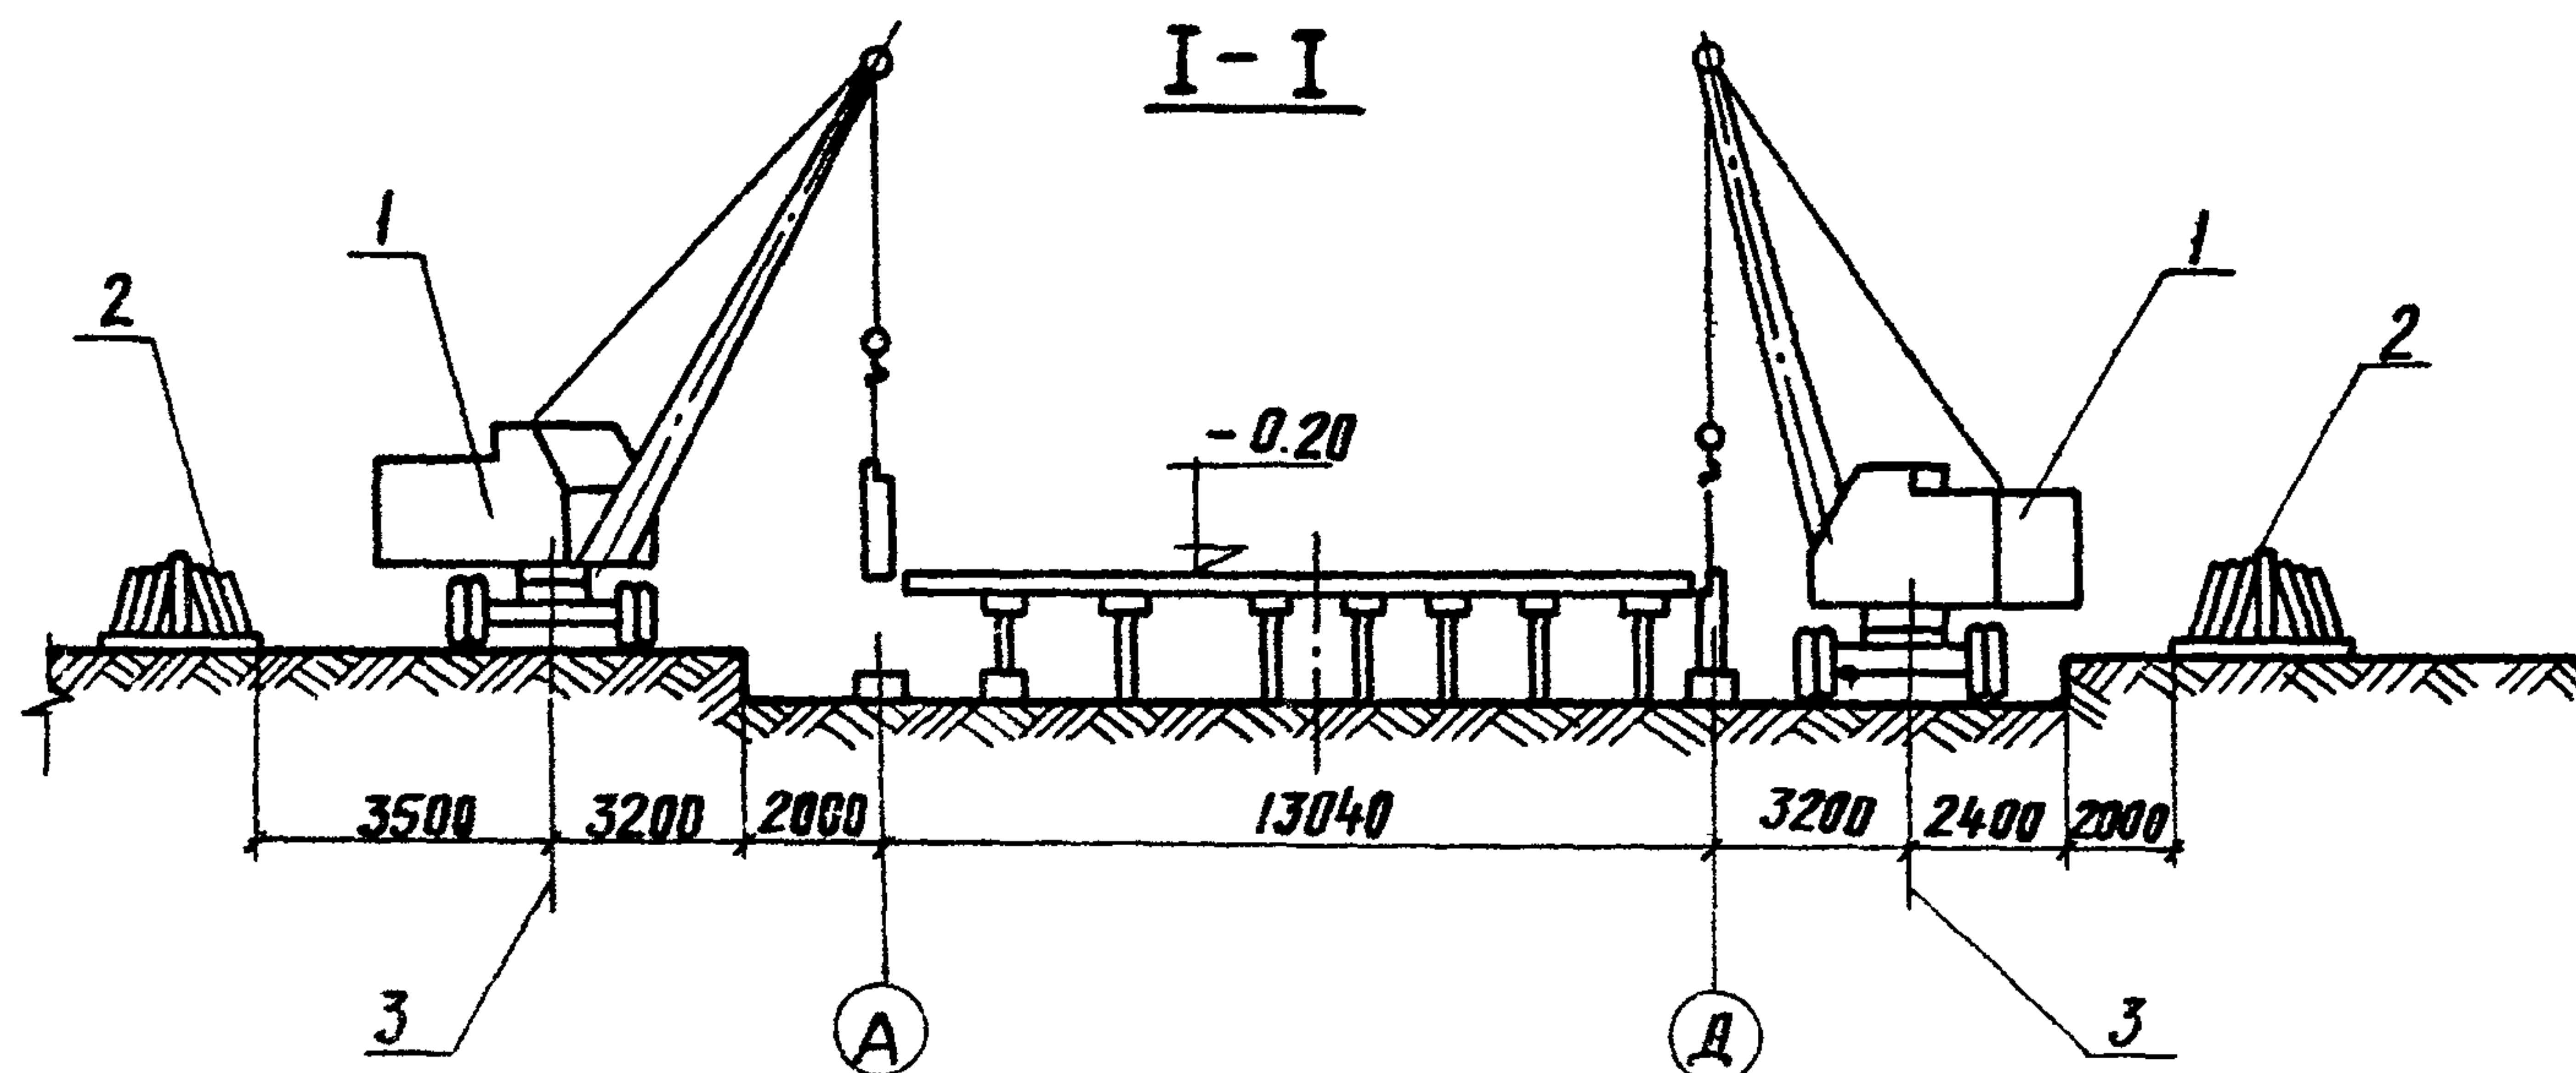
Монтаж поперечных панелей: 1-пневмоколёсный кран К-16 I;
